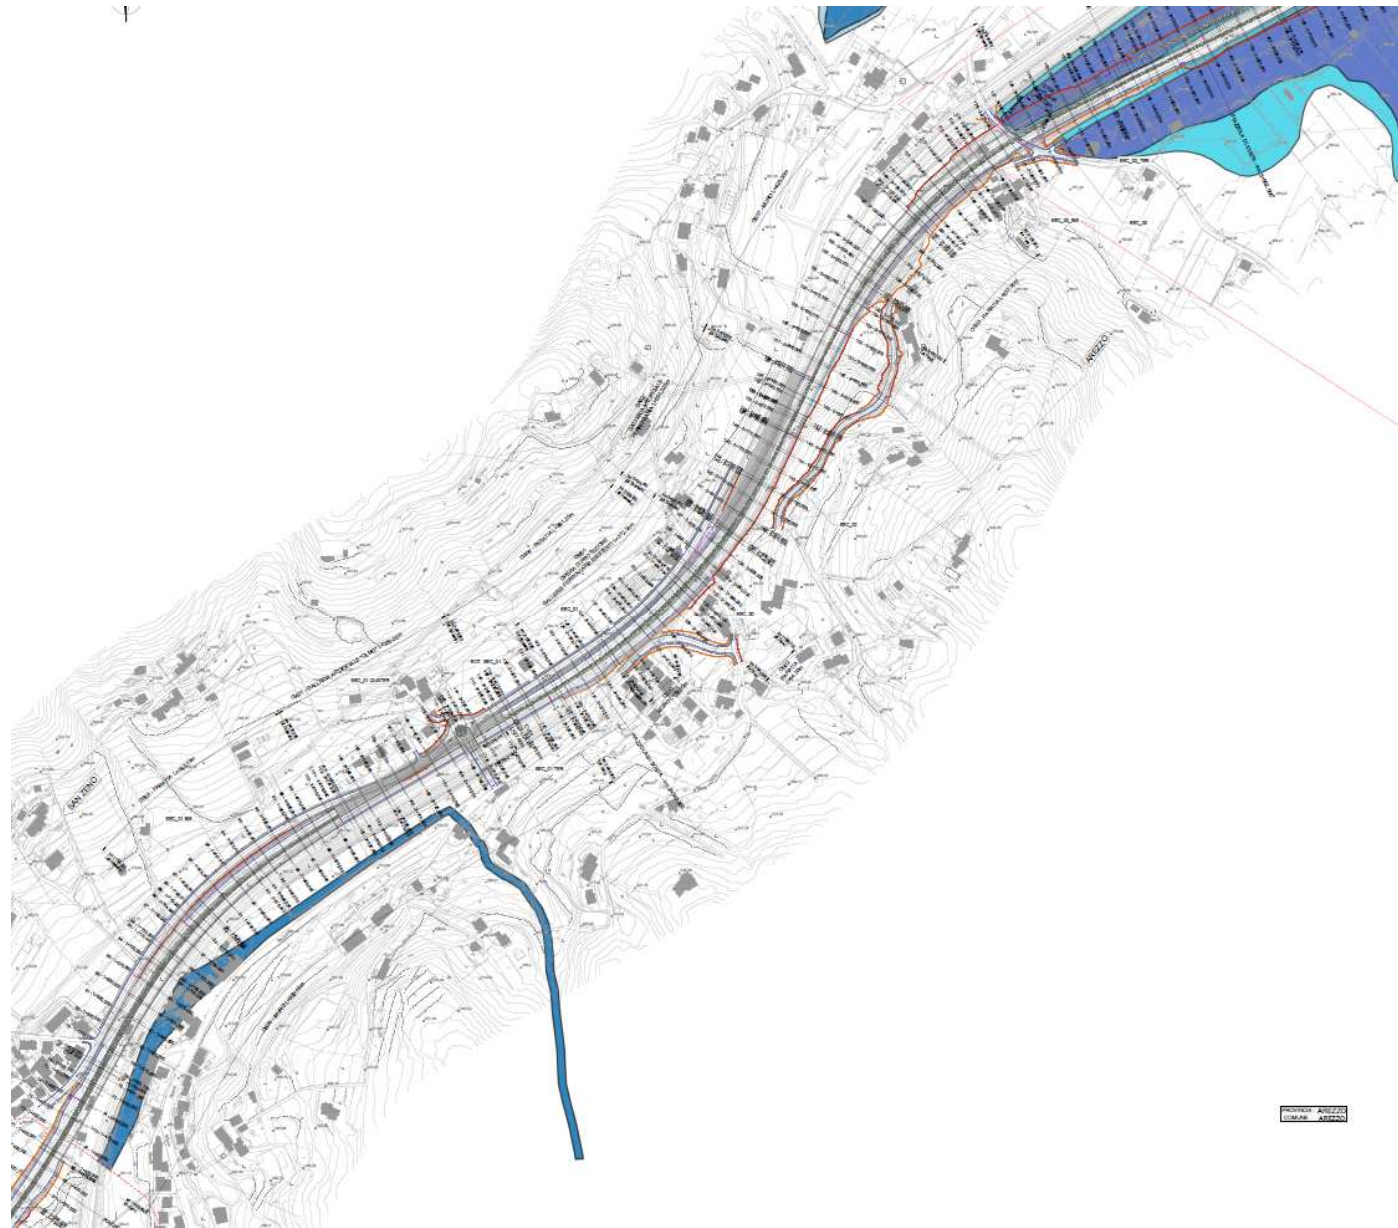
Estratto elaborato T00ID00IDRPL02/03 – Planimetria idraulica Tav.2 di 7 e 3 di 7
